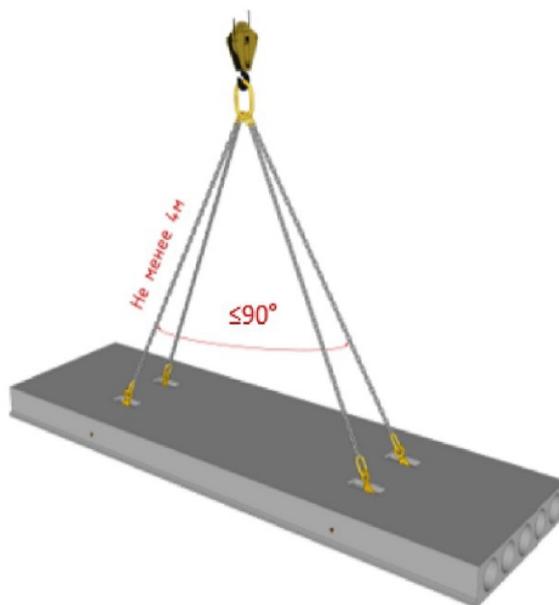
Схема строповки пустотных плит перекрытий (клещевыми захватами и с петлями).
